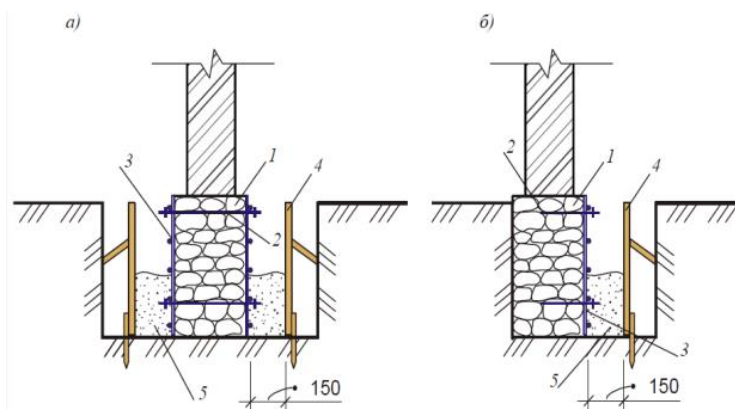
Усиление бутовых фундаментов путем устройства железобетонной обоймы: а-двусторонней, б-односторонней: 1-бутовый фундамент, 2-анкер, 3-арматурная сетка, 4-опалубка, 5-бетонная смесь.
